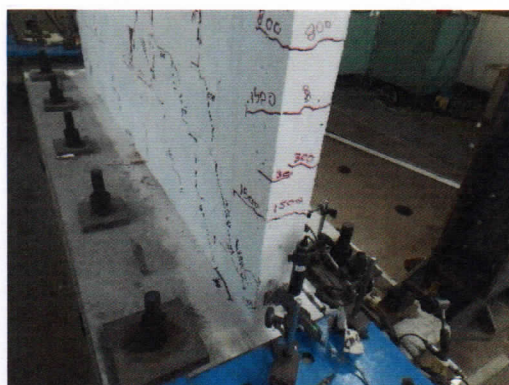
Separación de ladrillo con mortero a lo largo de grieta diagonal en la parte Este de la cara Norte para una distorsión de 1/300.
